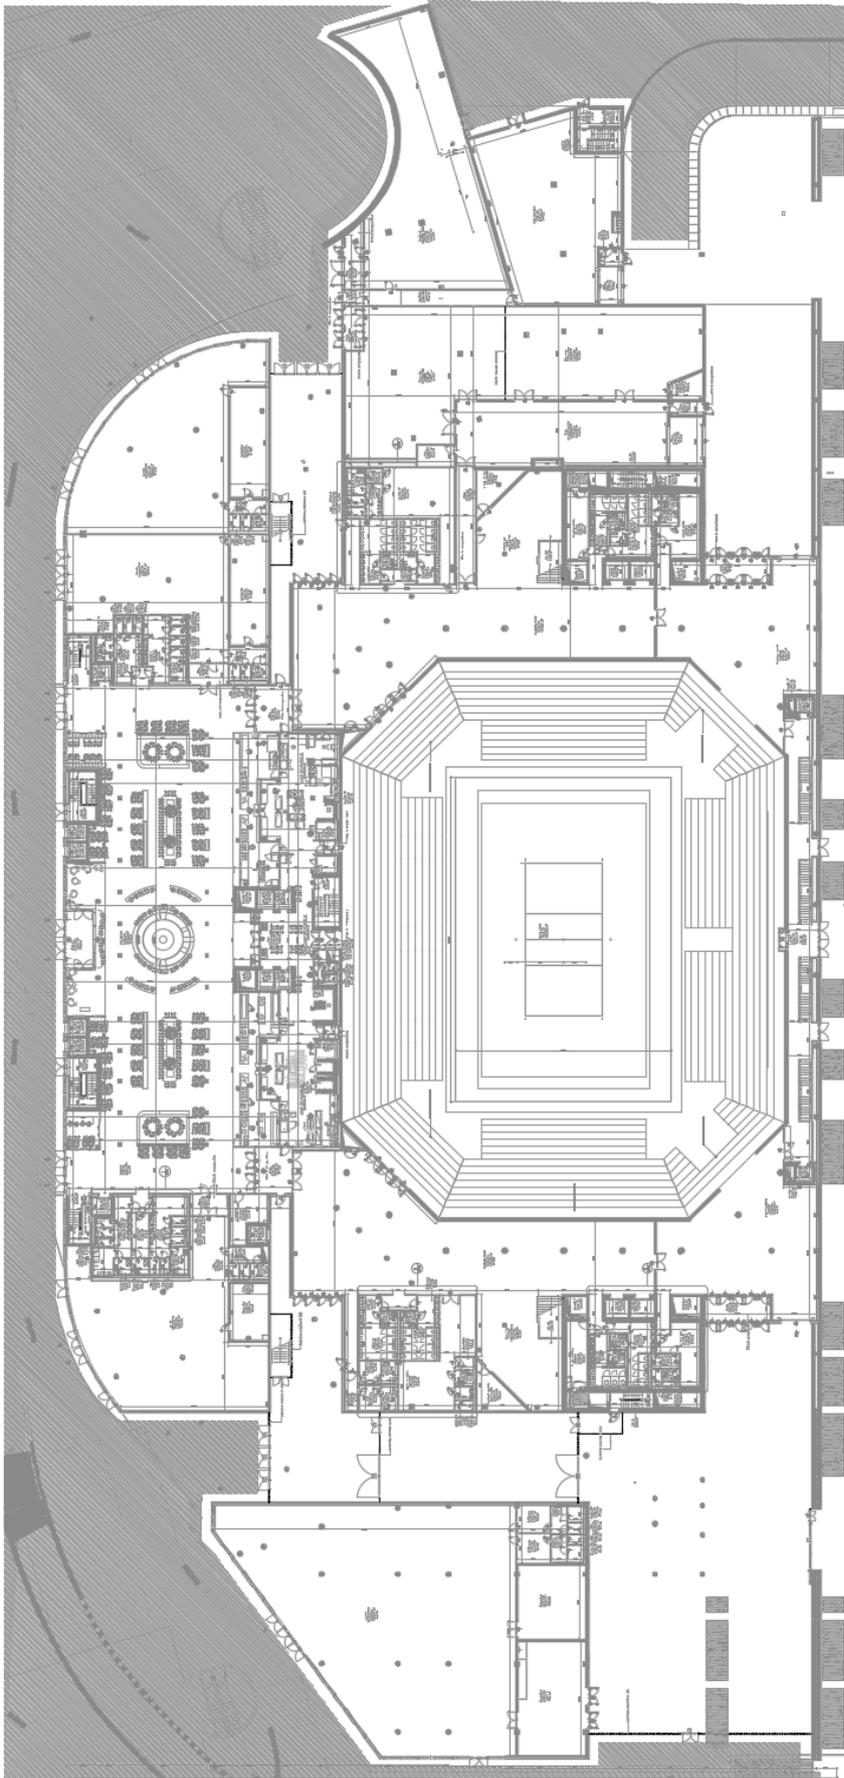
Pianta del parterre (Fonte: Studio GAe Engineering)
